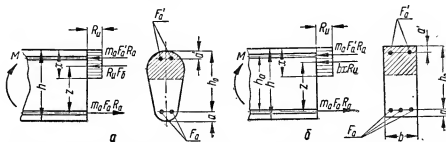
Расчетное напряженное состояние в сечении изгибаемого элемента с двойной арматурой:
